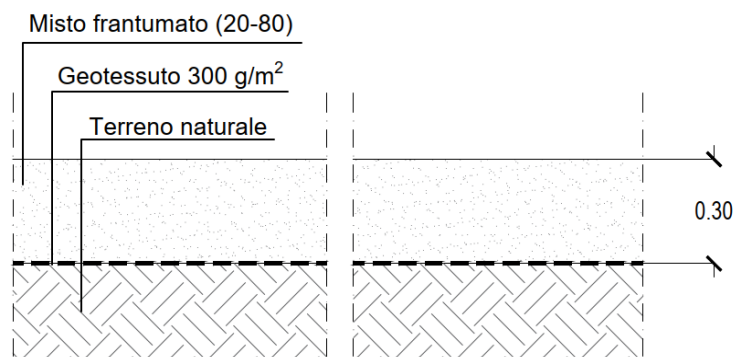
Tipologico piste di cantiere – stralcio Tavola “Allegato 10_Viabilità”
